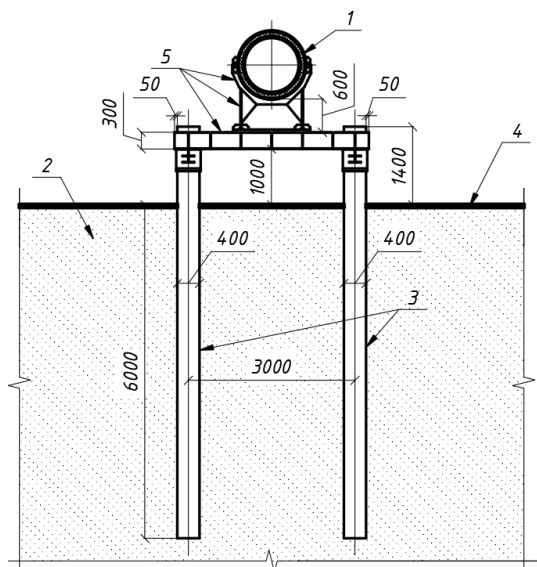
Схема надземной прокладки трубопровода в песчаном мёрзлом грунте: 1 – тело трубопровода; 2 – песчаный грунт основания; 3 – опорные сваи; 4 – моховый слой; 5 – конструкция опоры
